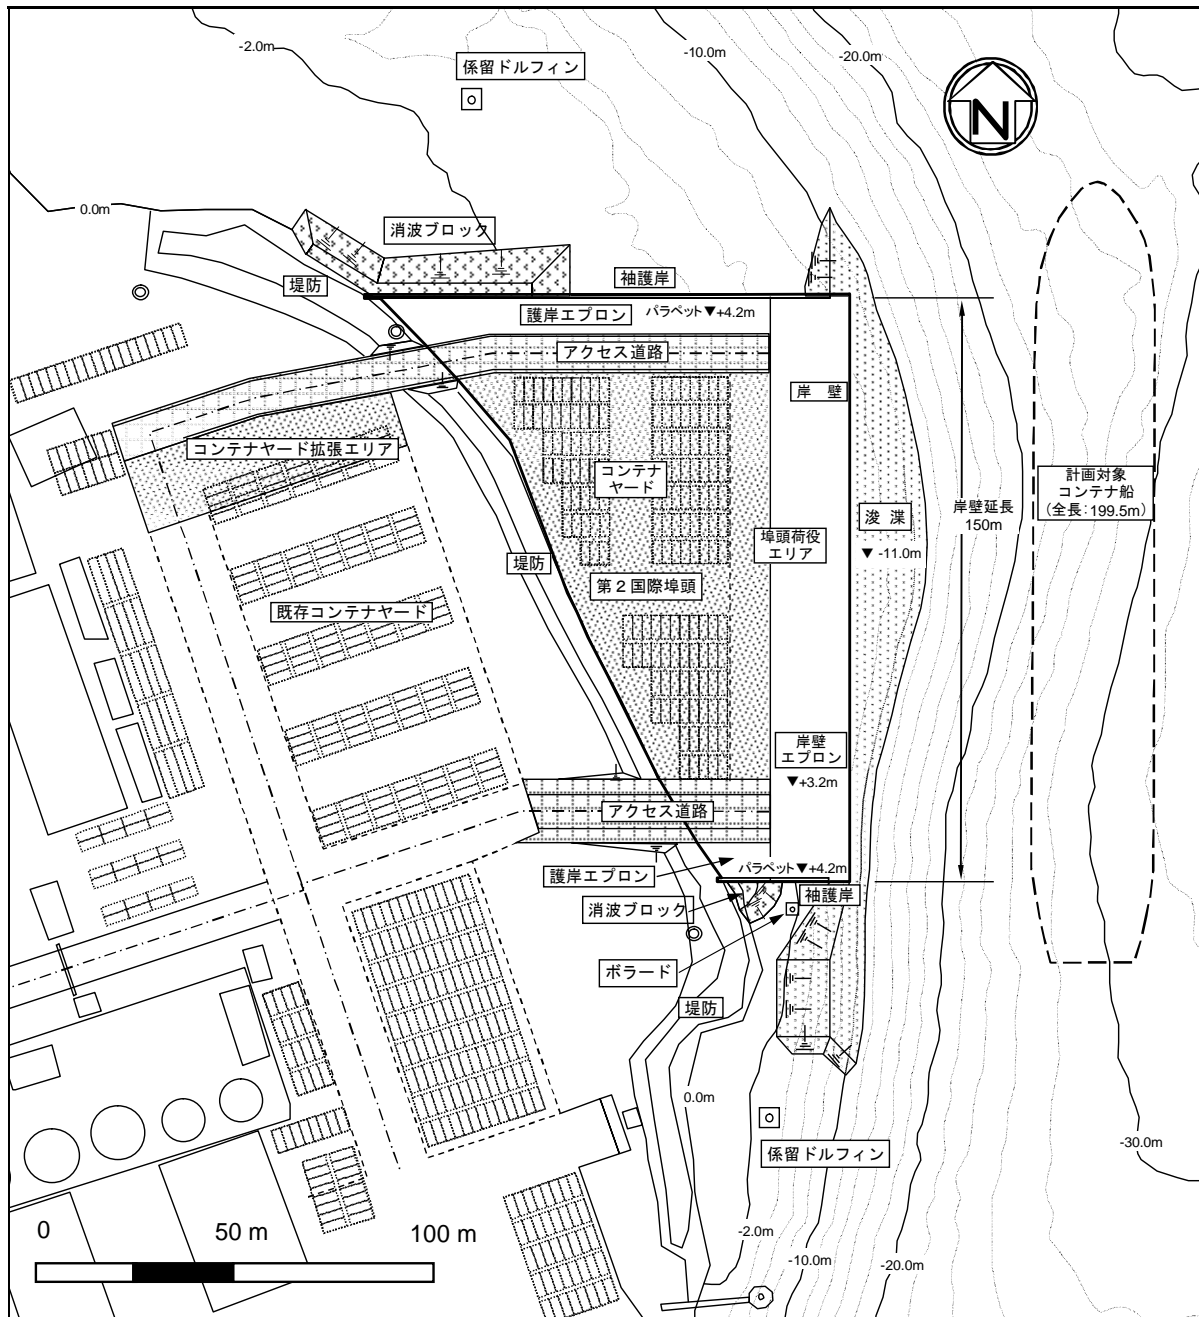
第二国際埠頭の概略計画平面図
